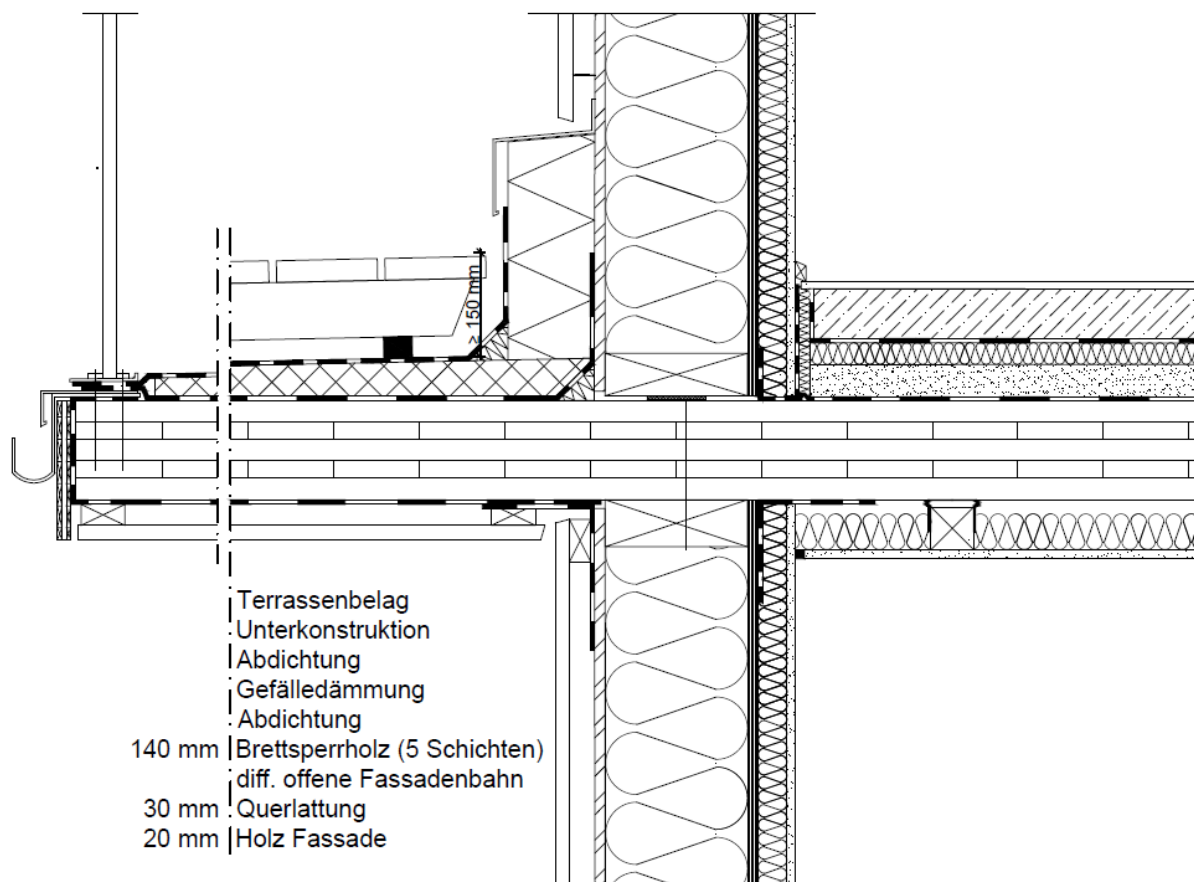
Anschlussdetail Auskragende BSP Deckenplatte (gdmnxa01a) – Außenwand (Holzrahmenbauweise) (arhi01a-03) mit Überdämmung im Sockelbereich
